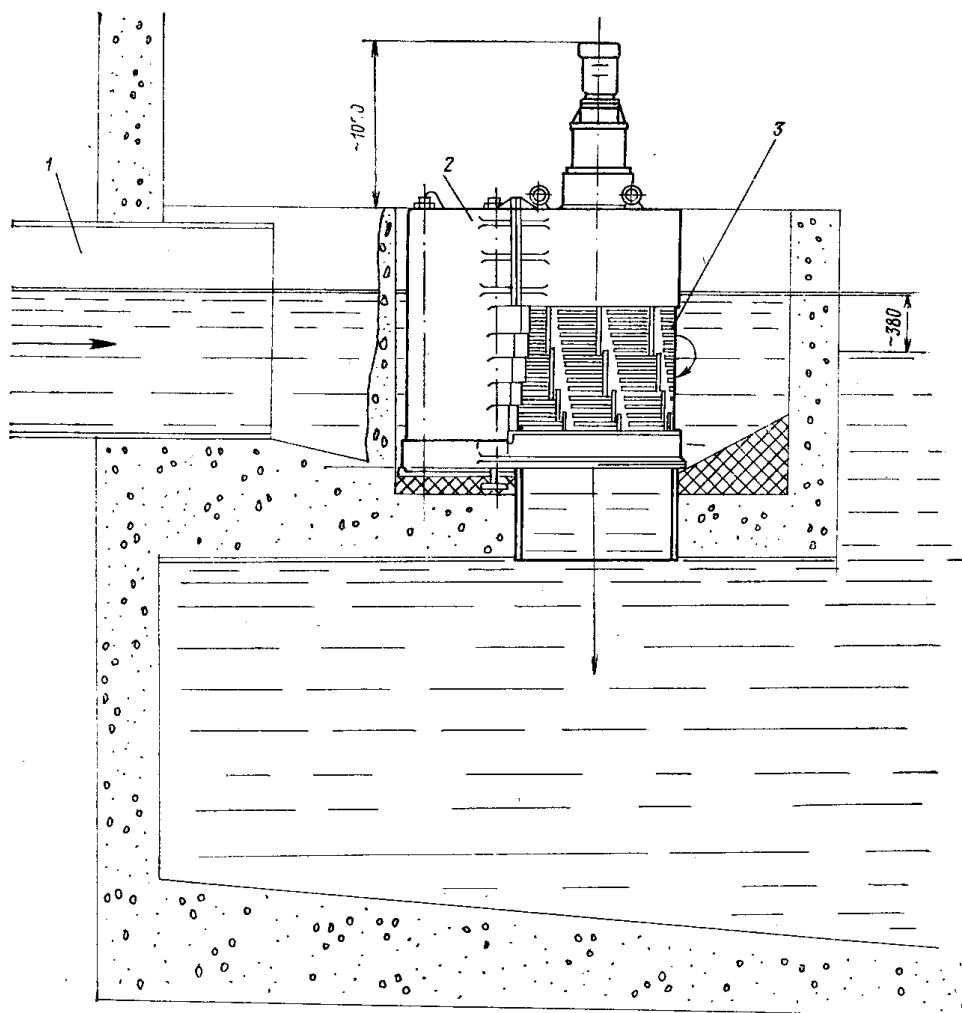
Решетка-дробилка РД-900 с изливом в резервуар
